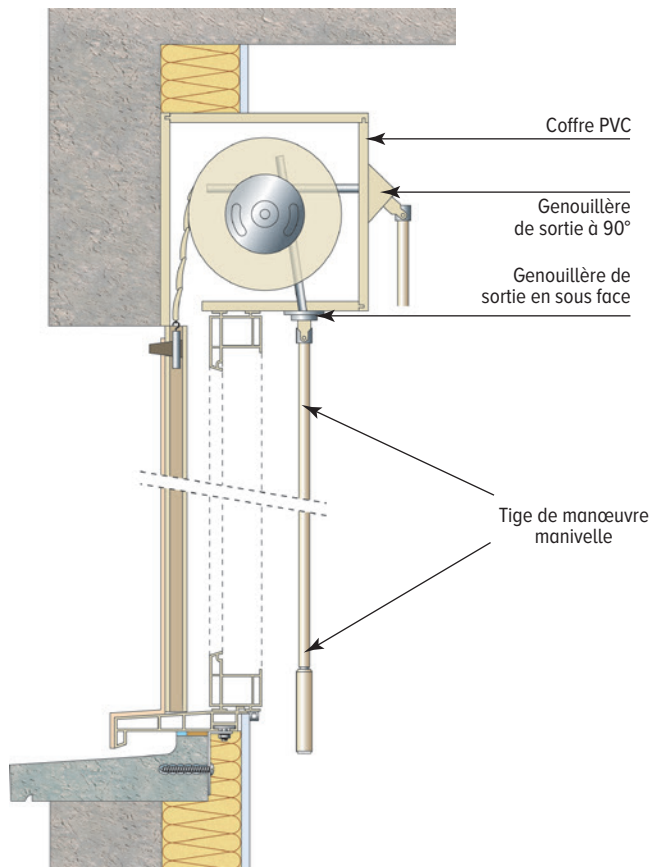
Coupe verticale pour une pose en neuf avec enroulement intérieur. Exemple d'une sortie de treuil en façade de coffre et d'une sortie de treuil en sous-face du coffre.
